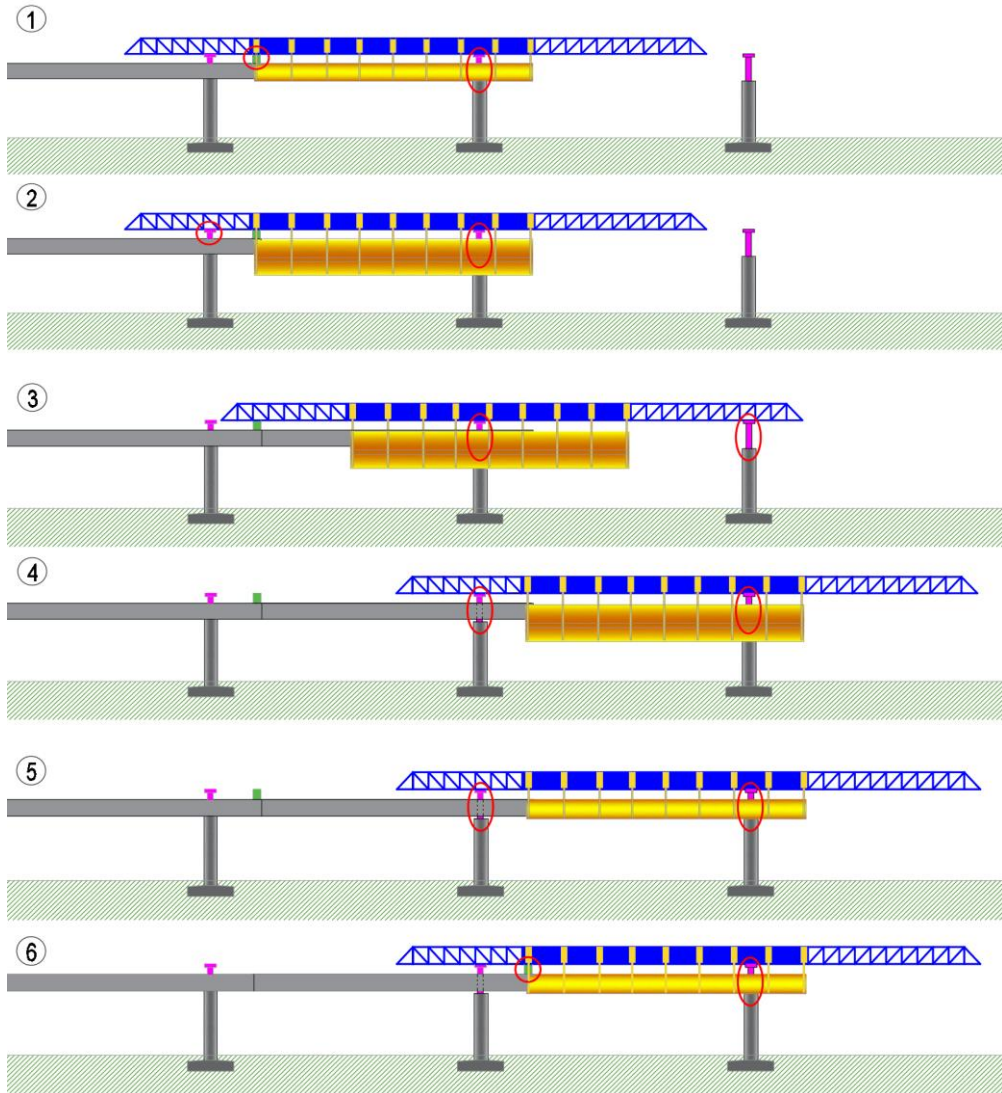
Hlavné časti výsuvnej skruže s horným trámom
